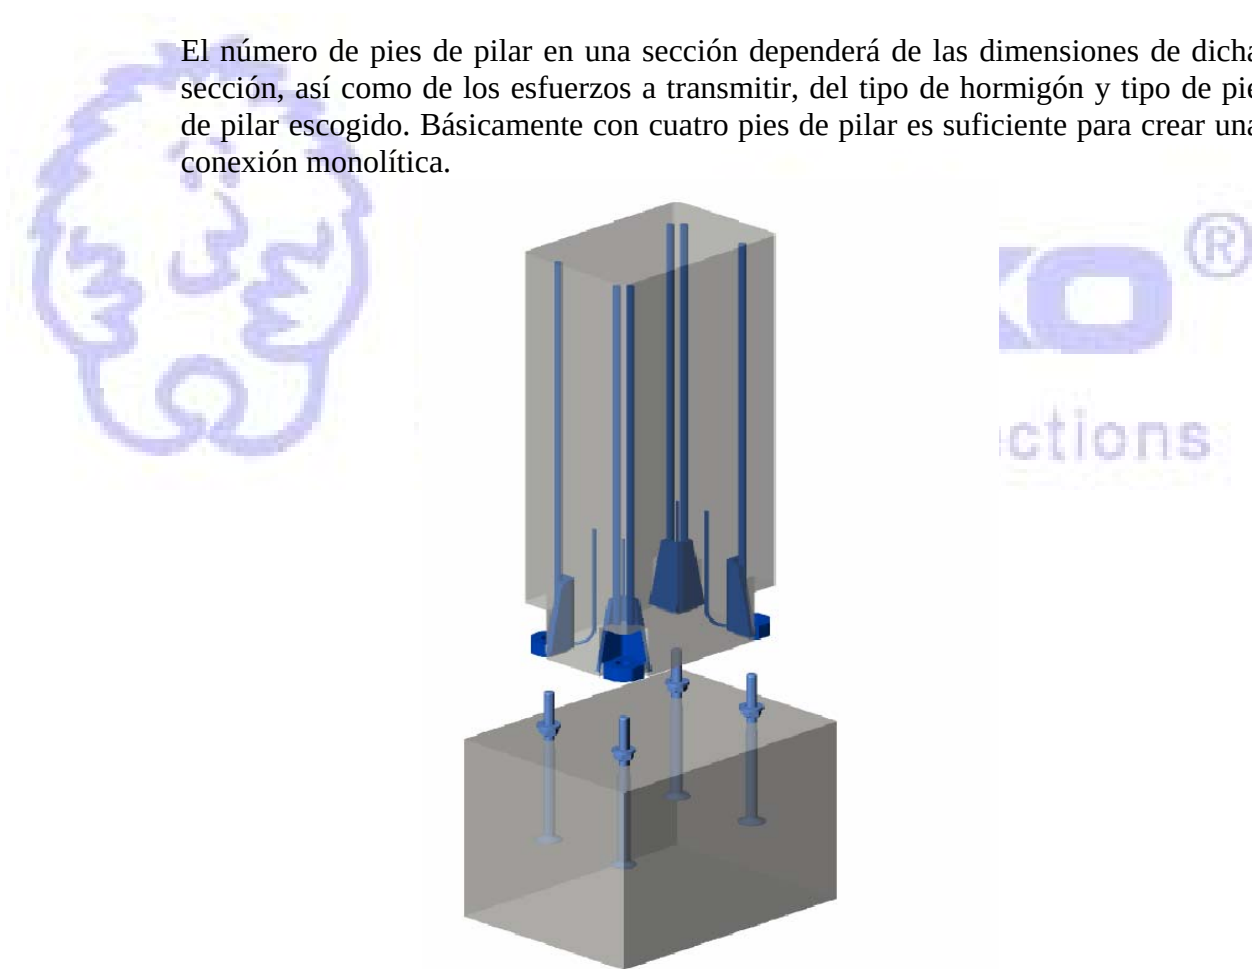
Pies de pilar y tornillos de anclaje en una típica conexión.
